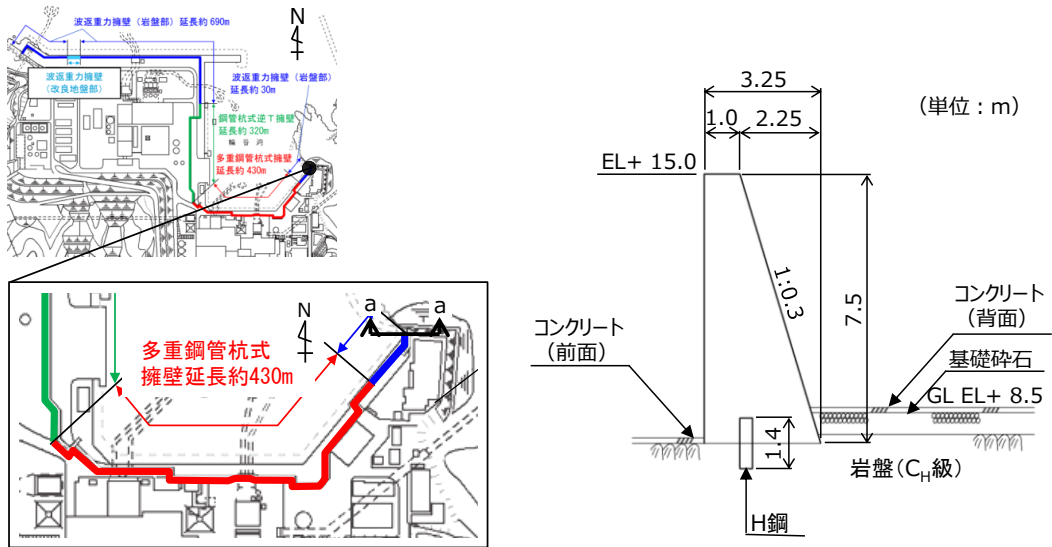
防波壁 (波返重力擁壁) 東端部 (a-a 断面) 断面図
